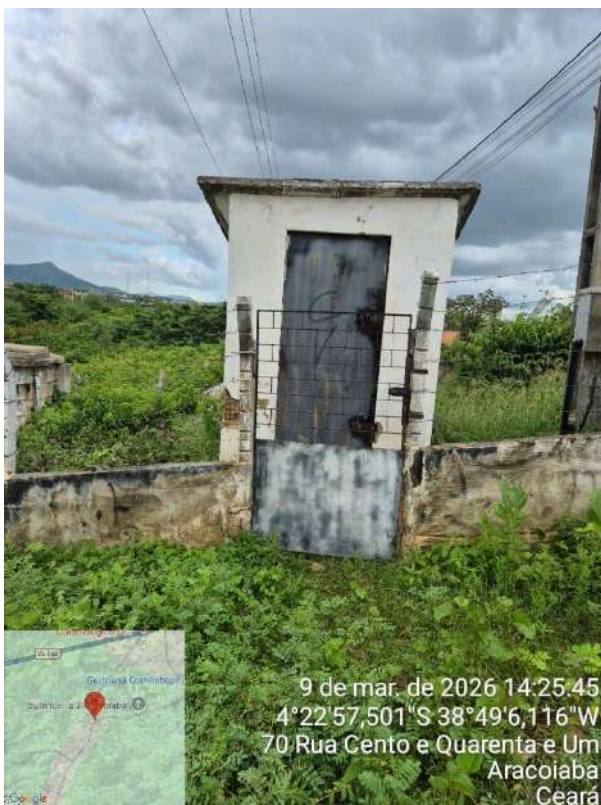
EERD-01: vegetação elevada, portão e porta oxidados, mureta com manchas de umidade e escorrimento, pintura deteriorada e suja, vedação precária.
